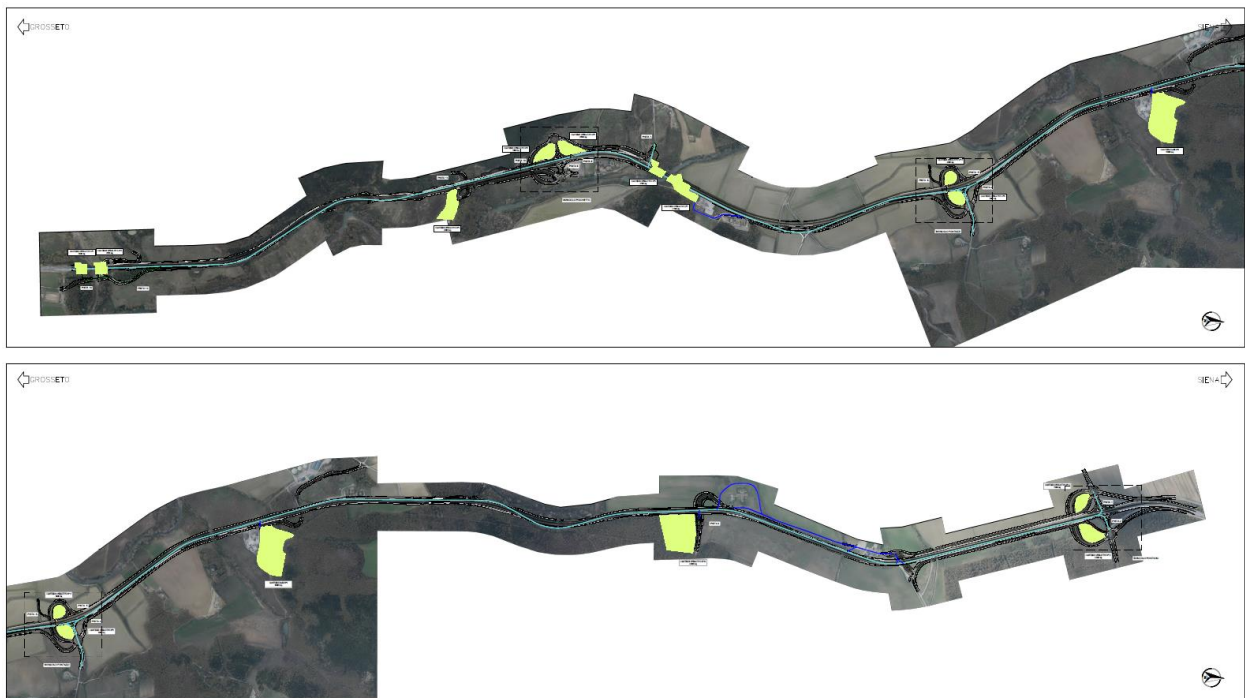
Planimetria con individuazione dei cantieri base e operativi.
